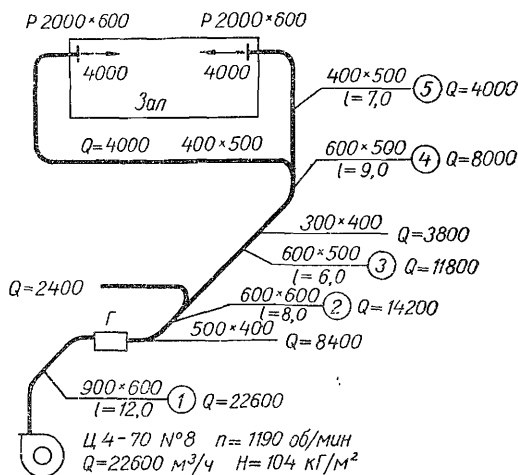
Расчетная схема воздухопроводов к примеру 62.
